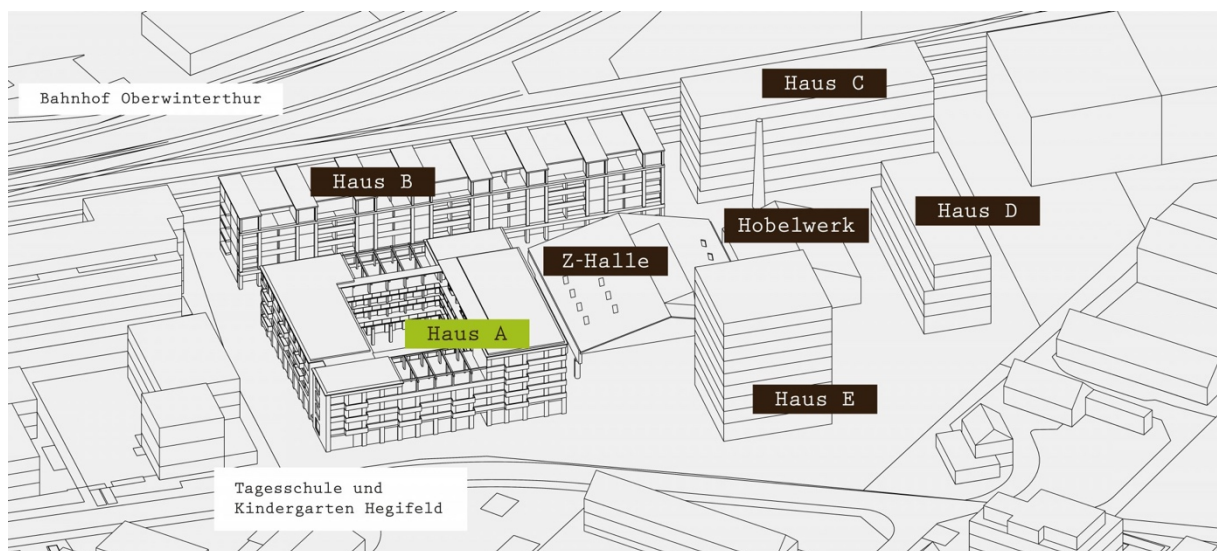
Lageplan des Hobelwerks mit Bauabschnitten A - E (mehr als wohnen, 2020)
